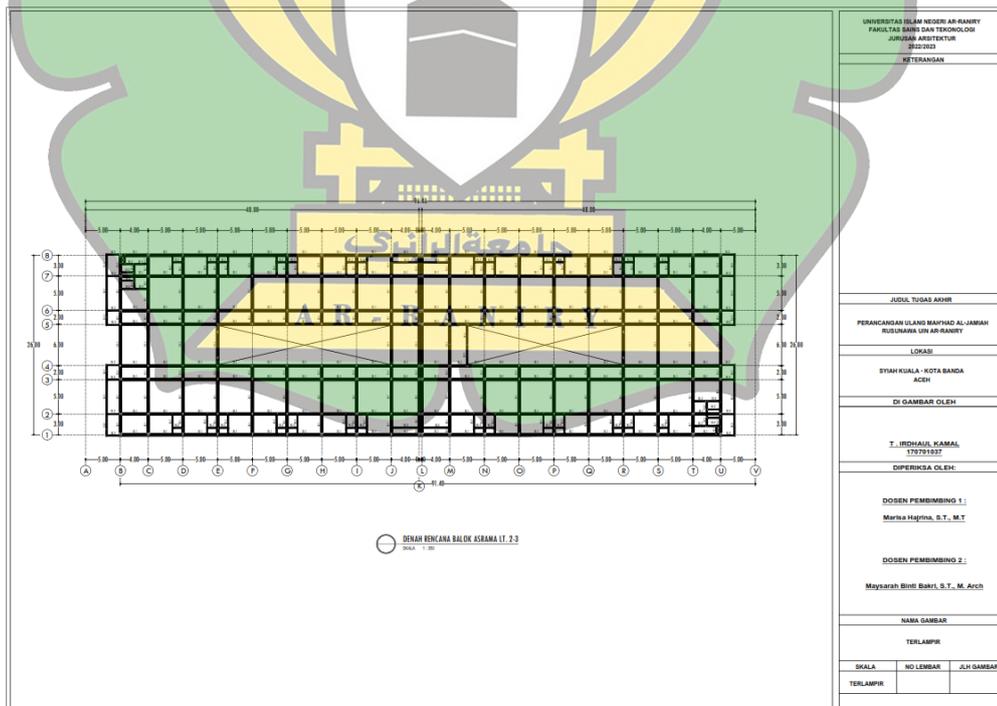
Denah Rencana Balok Latei Asrama Lantai 1 – 4
